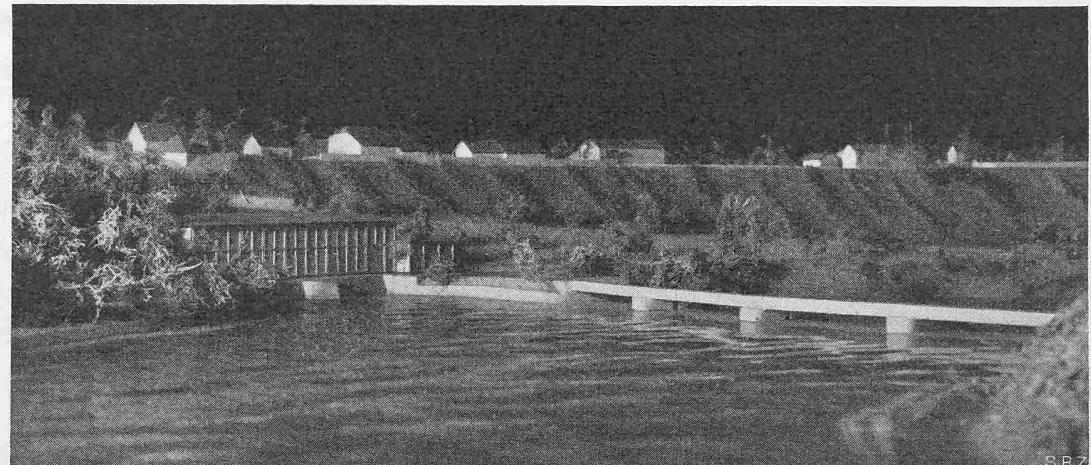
Modellaufnahme des Maschinenhauses mit Stauwehr von Südosten. Photo Wolf Bender Erben, Zürich
